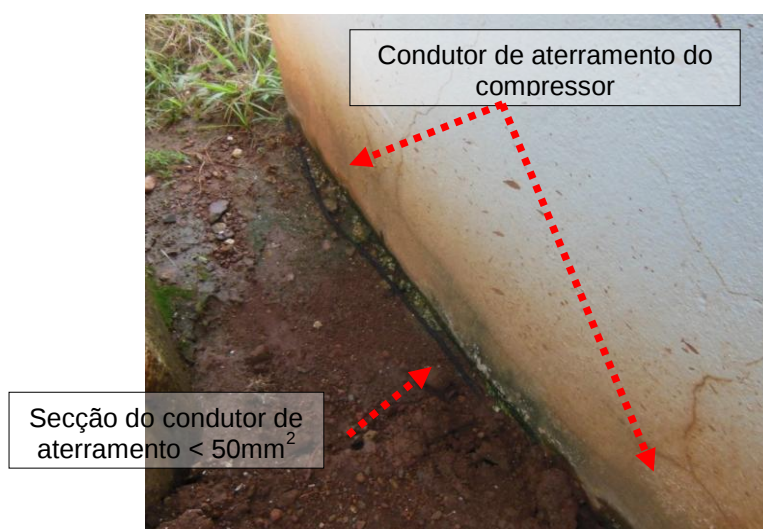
Aterramento de elemento metálico não constante em planta / Secção < 50mm².
